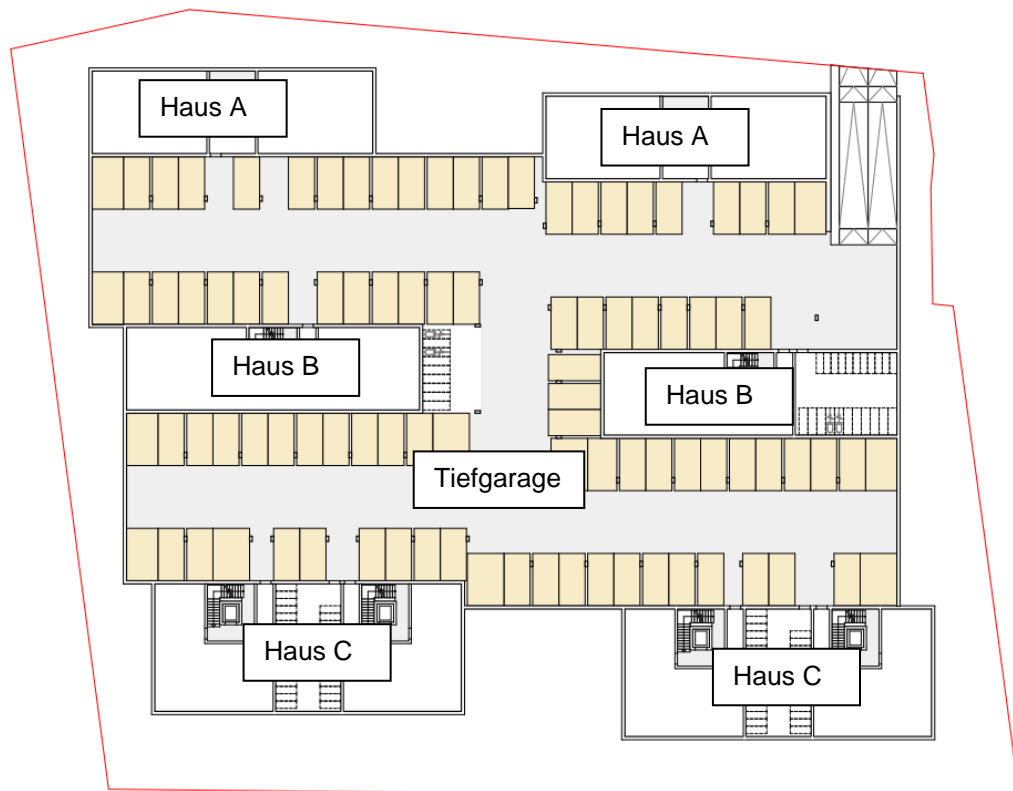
Lage und Grundriss Tiefgarage
